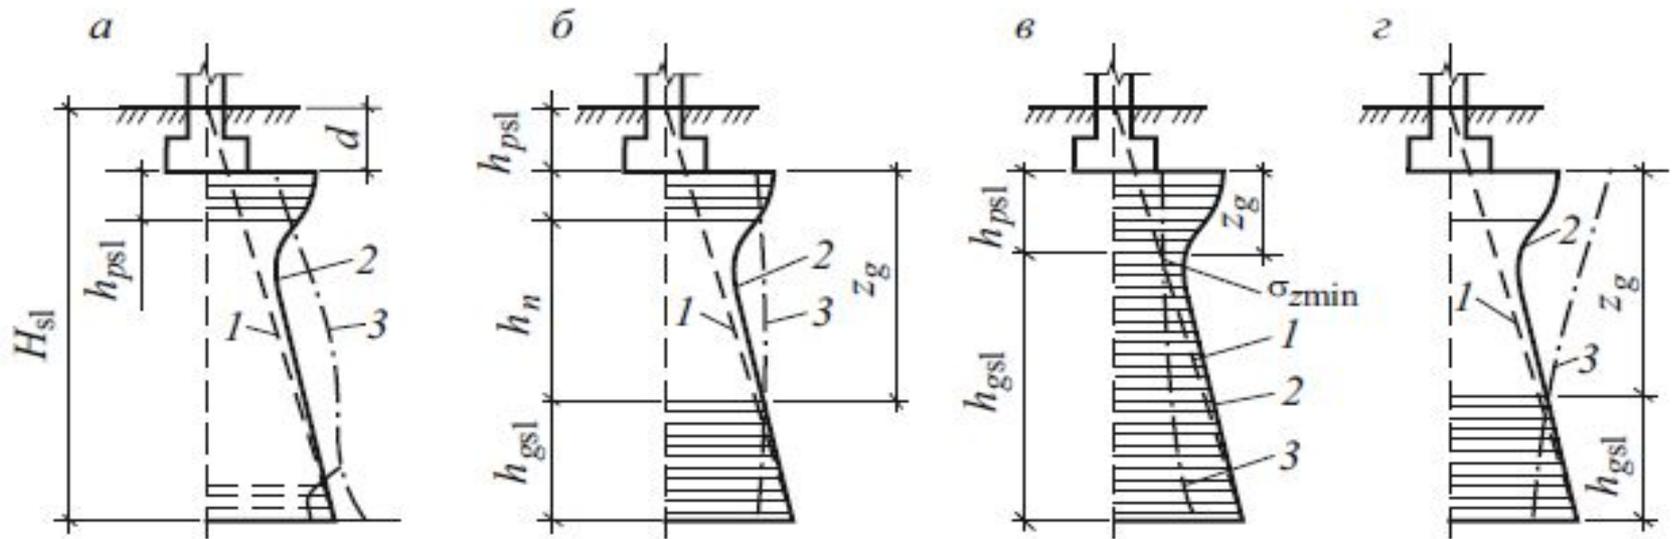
Схемы к расчету просадок основания: а – I тип грунтовых условий; б, в, г – II тип грунтовых условий; 1 – эпюра вертикальных напряжений от собственного веса грунта σ_{zg} ; 2 – эпюра суммарных вертикальных напряжений от внешней нагрузки и собственного веса грунта $\sigma_z + \sigma_{zg} + \sigma_{zp}$; 3 – изменение с глубиной начального просадочного давления p_{sl} ; H_{sl} – толщина слоя просадочных грунтов
